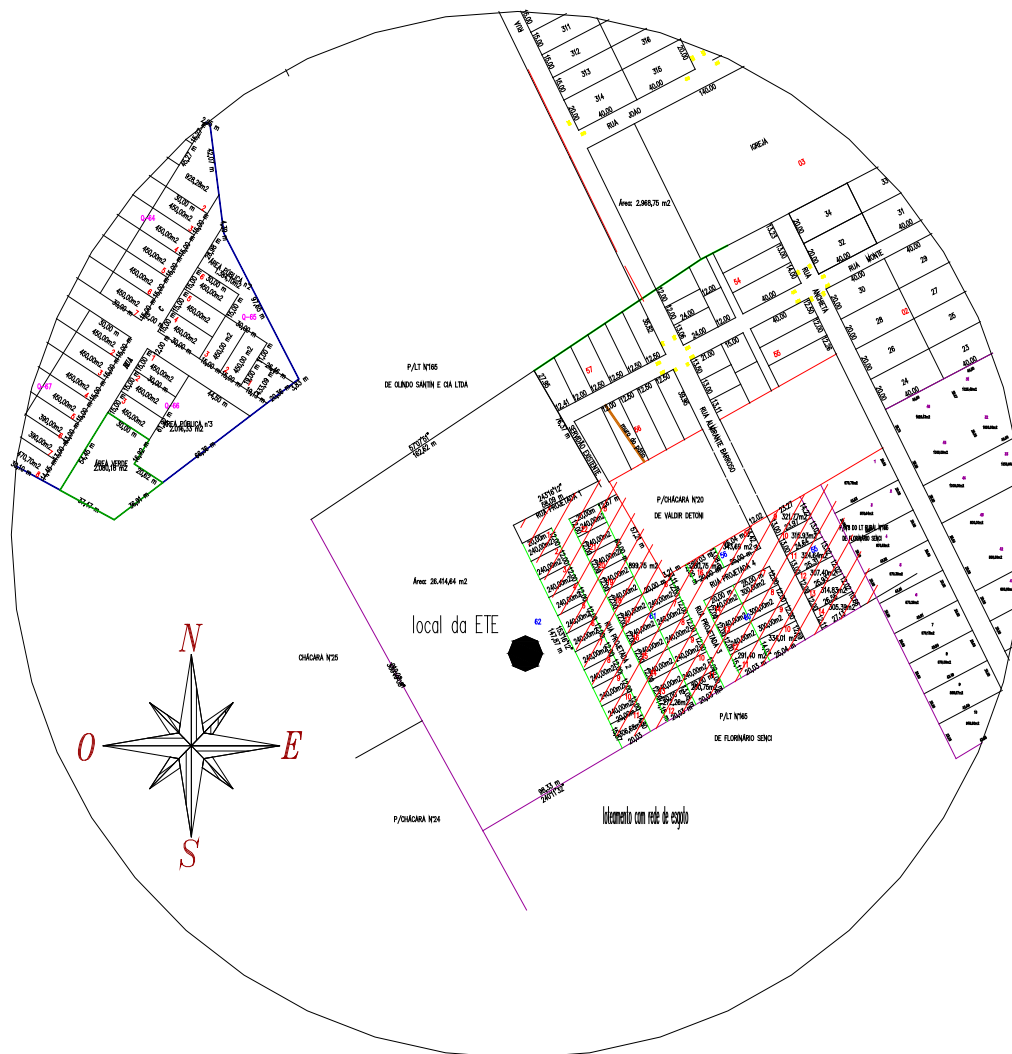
loteamento Vista Longa com localização da ETE.
